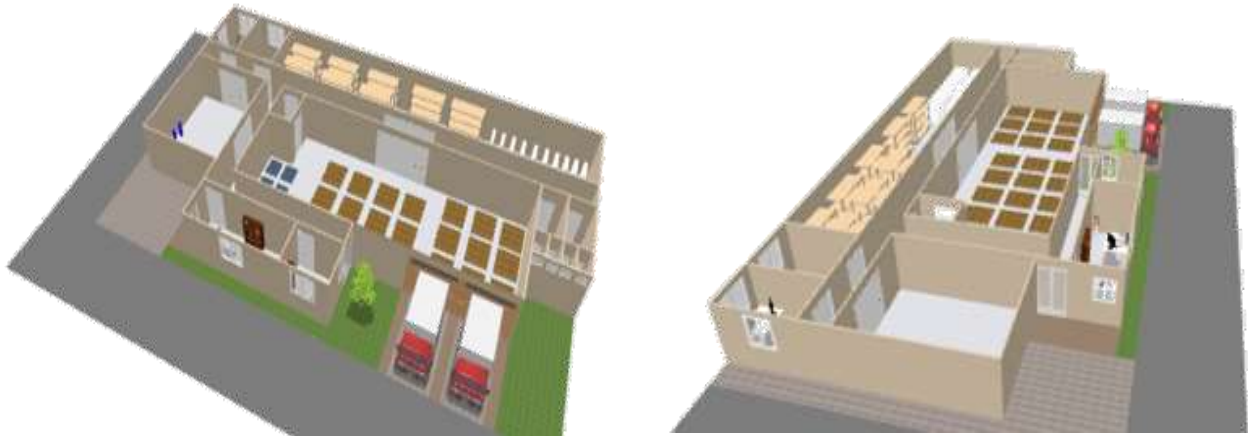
Layout de planta embotelladora, segunda alternativa. Imagen extraída de corelap.
